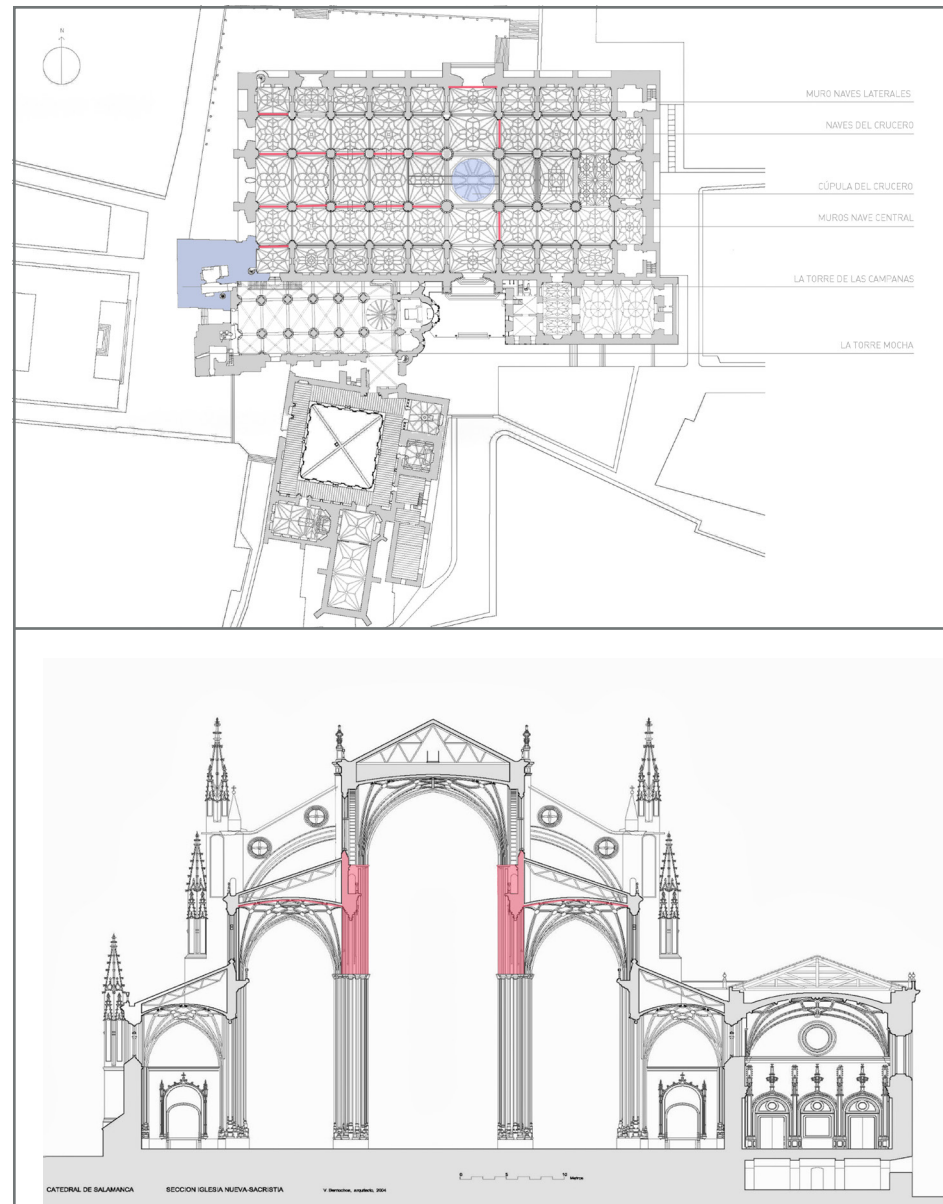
Localización de las principales patologías tras el Terremoto de Lisboa de 1755: Planta y sección.
